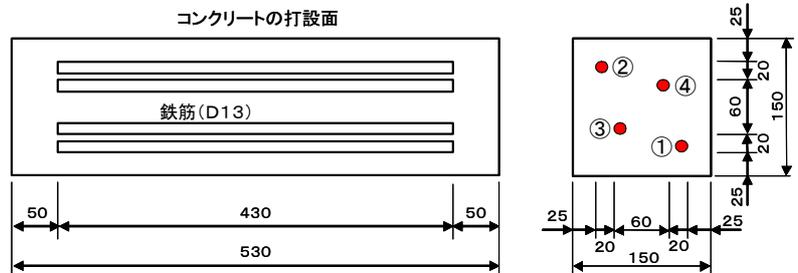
暴露試験体の形状と寸法(かぶりの検討, 単位: mm)
